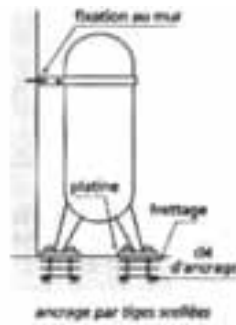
Exemple de fixation au sol et au mur d'un équipement lourd de type « chauffe-eau » (Source : Milan ZACEK)
